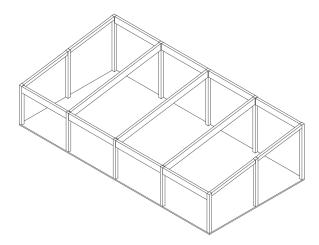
Axonometría estructural tipo 1_3 Fuente: Autores. 2024
